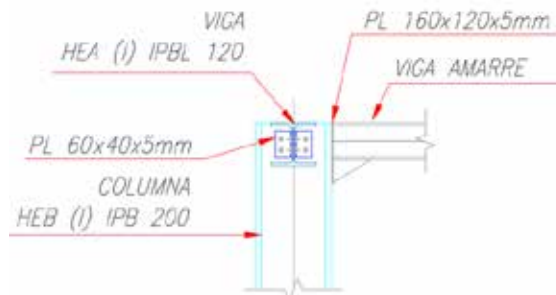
Detalle de Viga de Carga HEA 120 con Columna HEB 200. (2016).
